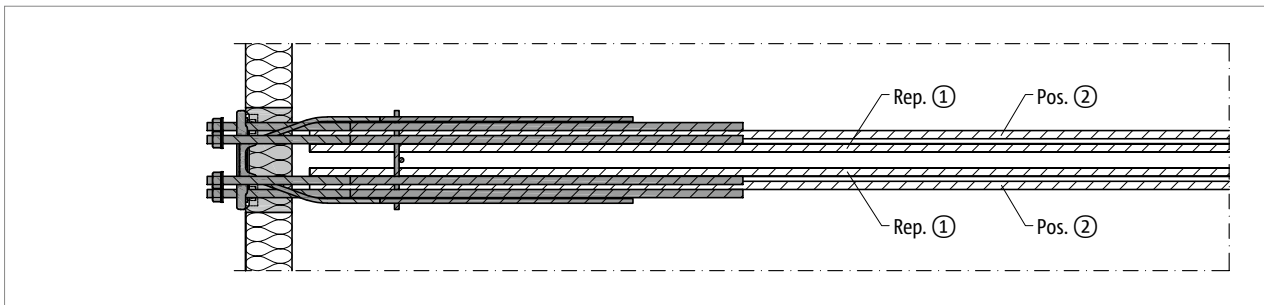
Schöck Isokorb® T type SK-MM1 : renforcement sur site, plan de base
